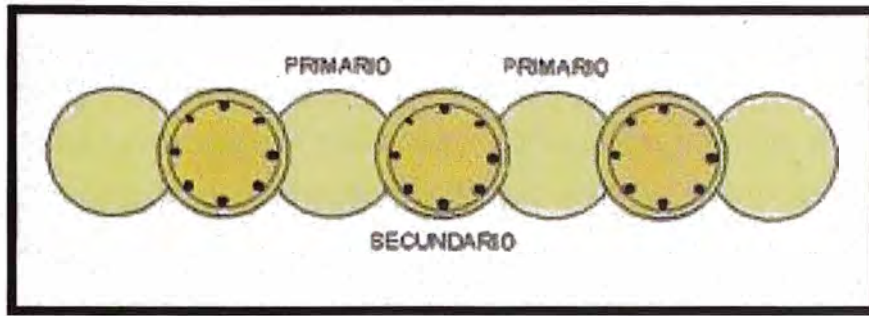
Secuencia de Pilotes Secantes (Pilotes Primarios con concreto simple y Los Secundarios de concreto armado)
